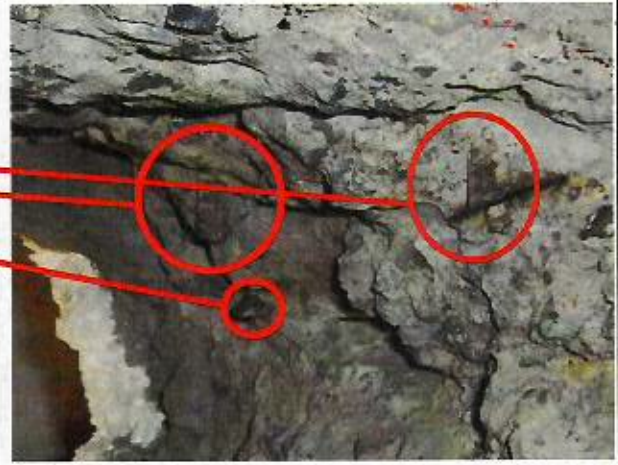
se observa armadura a la vista, por picado posterior de loza.
